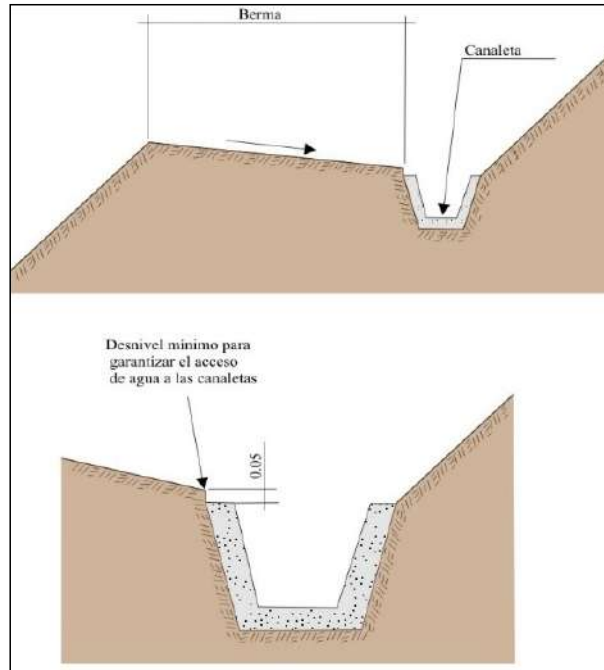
Detalle de una canaleta de drenaje superficial (tomado de Ingemmet, 2000)
